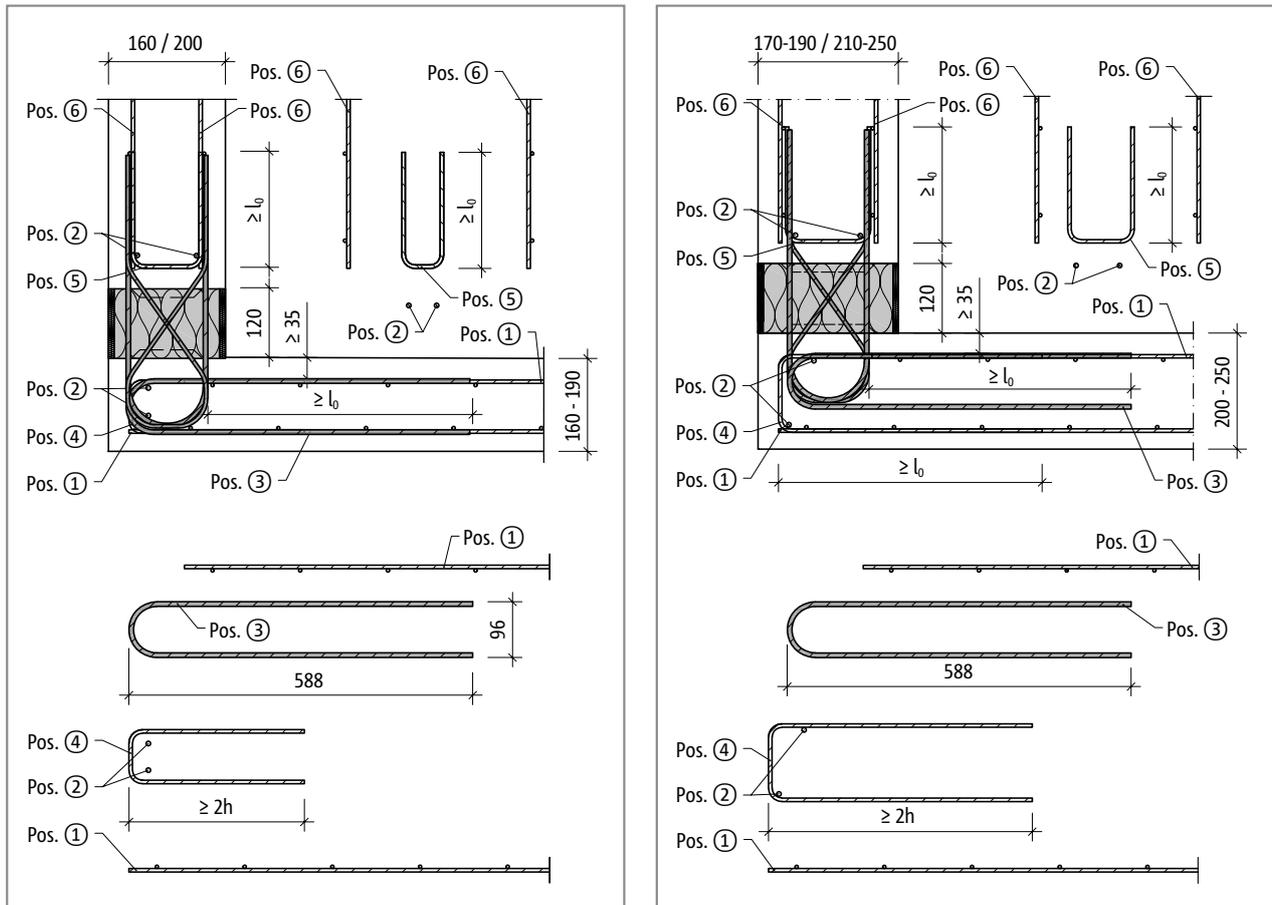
Schöck Isokorb® XT type A: On-site reinforcement on the inside ($B = 160$ and $B = 200$)
